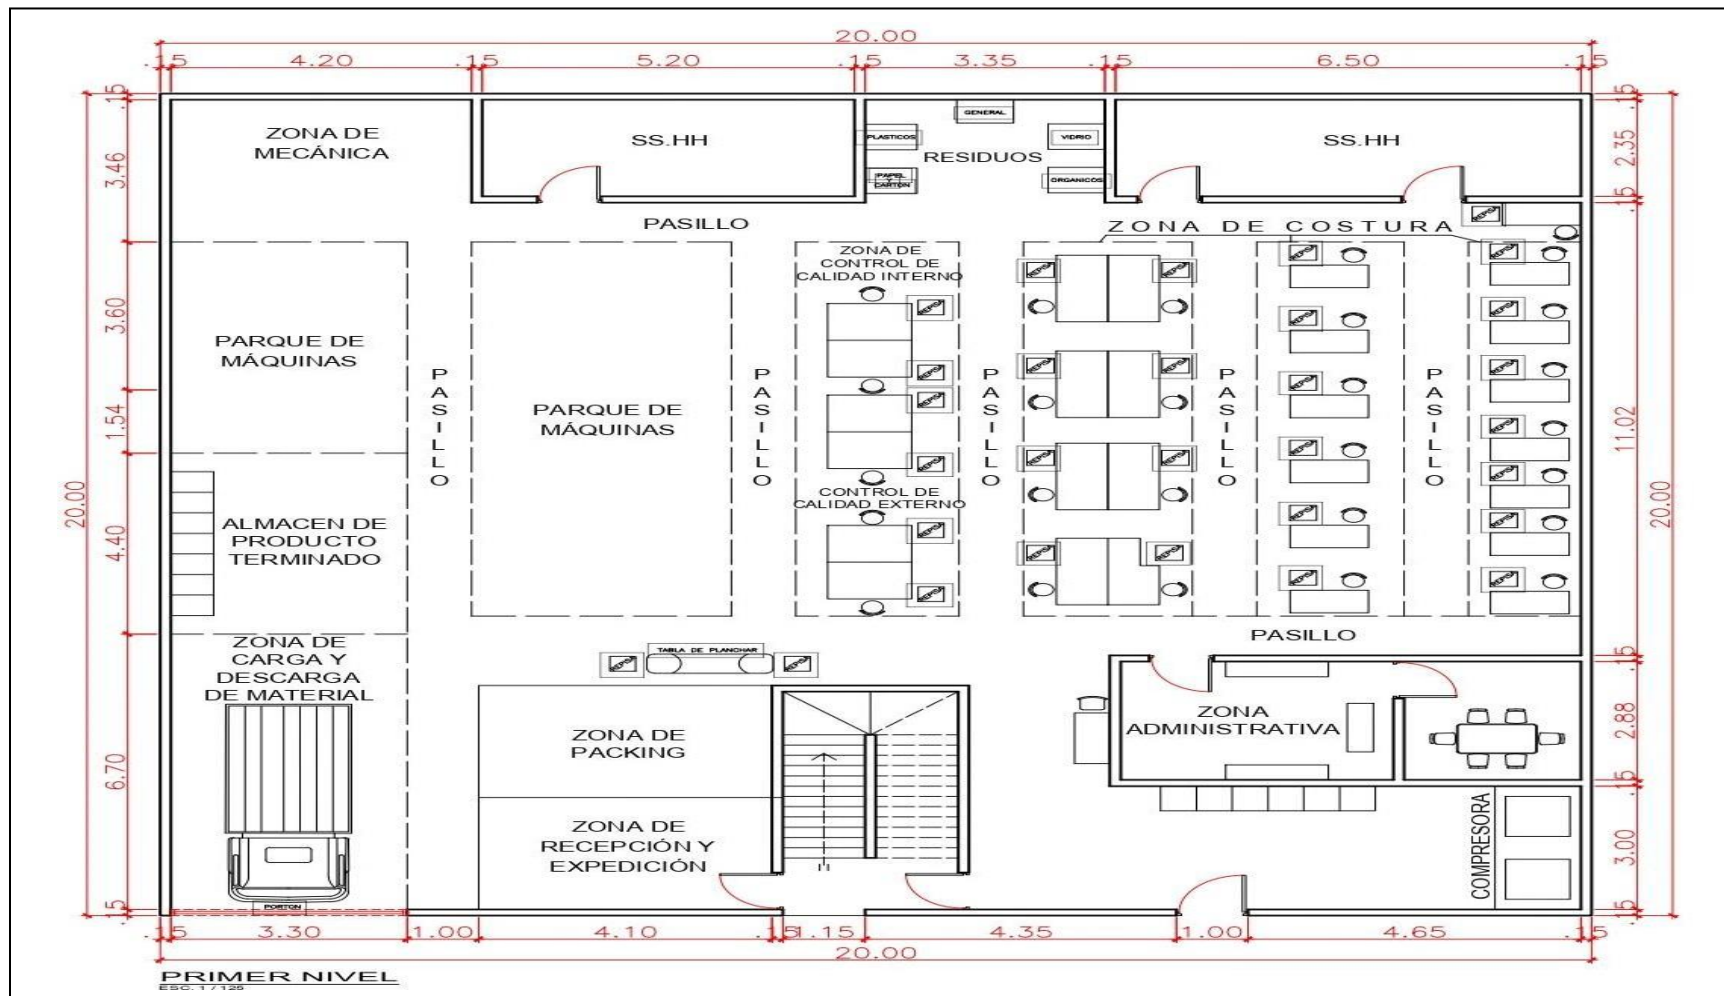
Distribución de planta del primer nivel en AutoCAD 2020 – Vista superior
